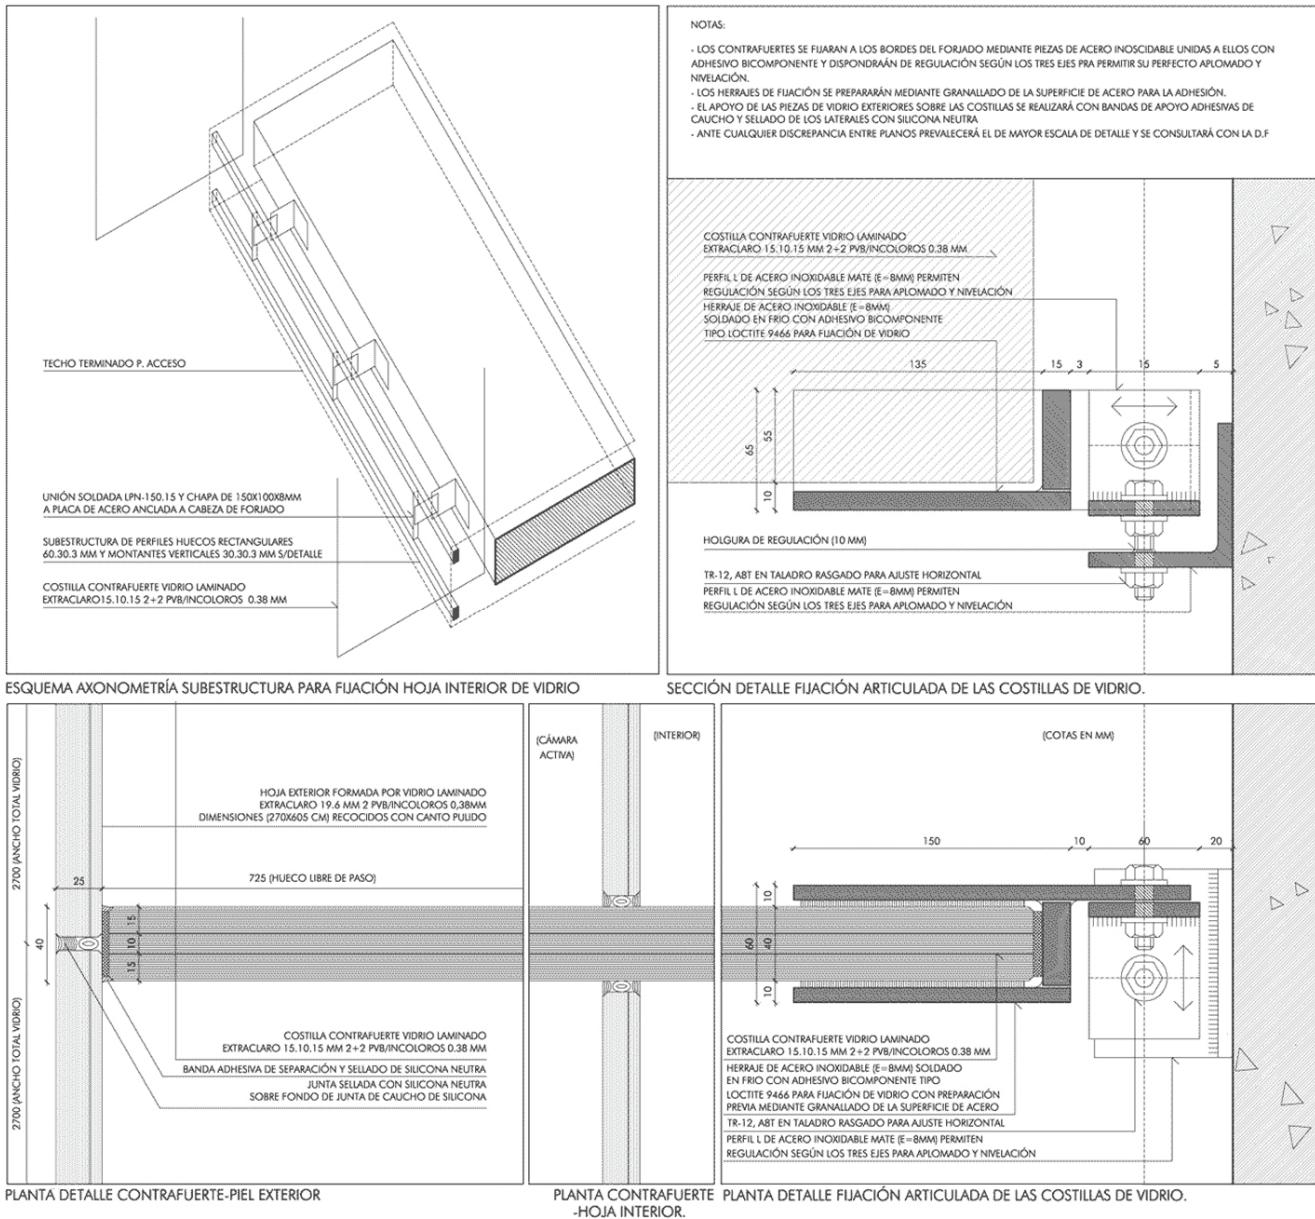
Detalles constructivos de fachada del edificio de oficinas en Zamora de Alberto Campo Baeza (3).
